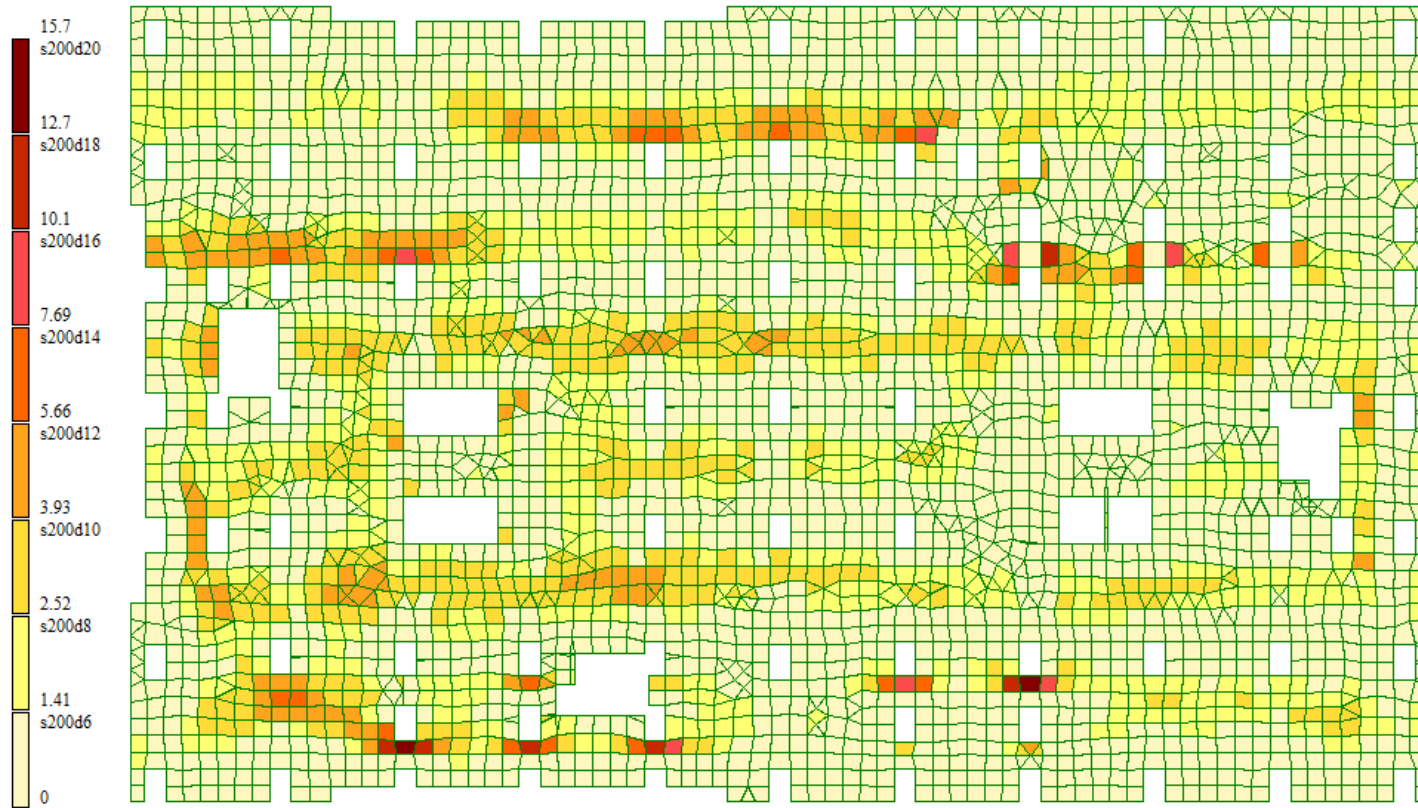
Схема армирования низа плиты перекрытия по оси OX и по оси OY
